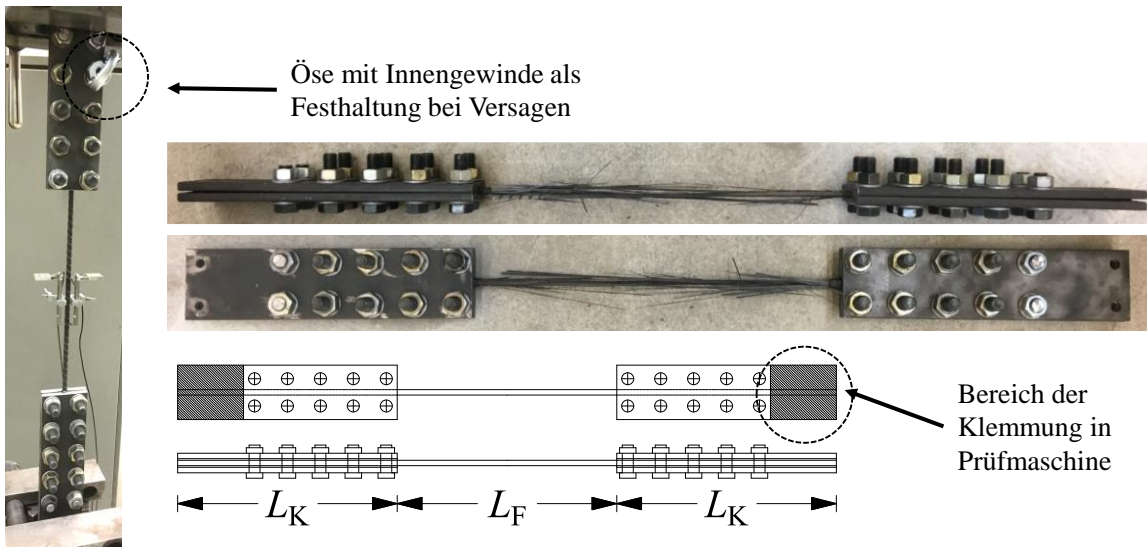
Zugversuch mittels verschraubter Stahlplatten
